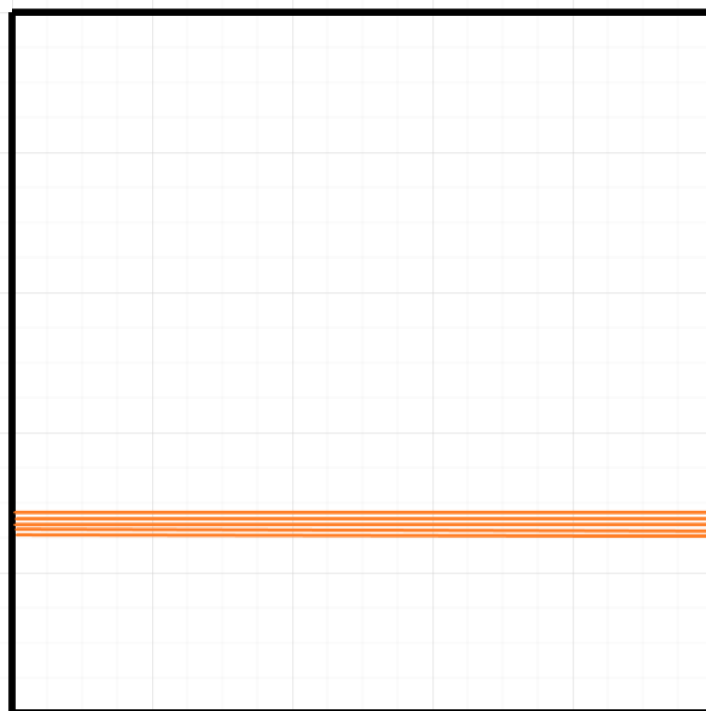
Схема прокладки проводов по стене, которую видно из комнаты.
